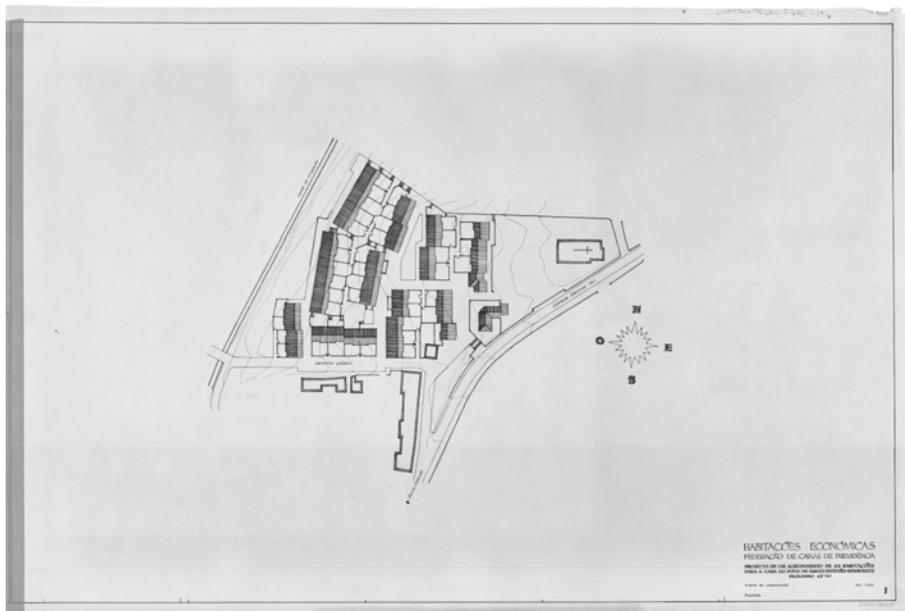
Bairro de Santo Estêvão. Planta de implantação.
